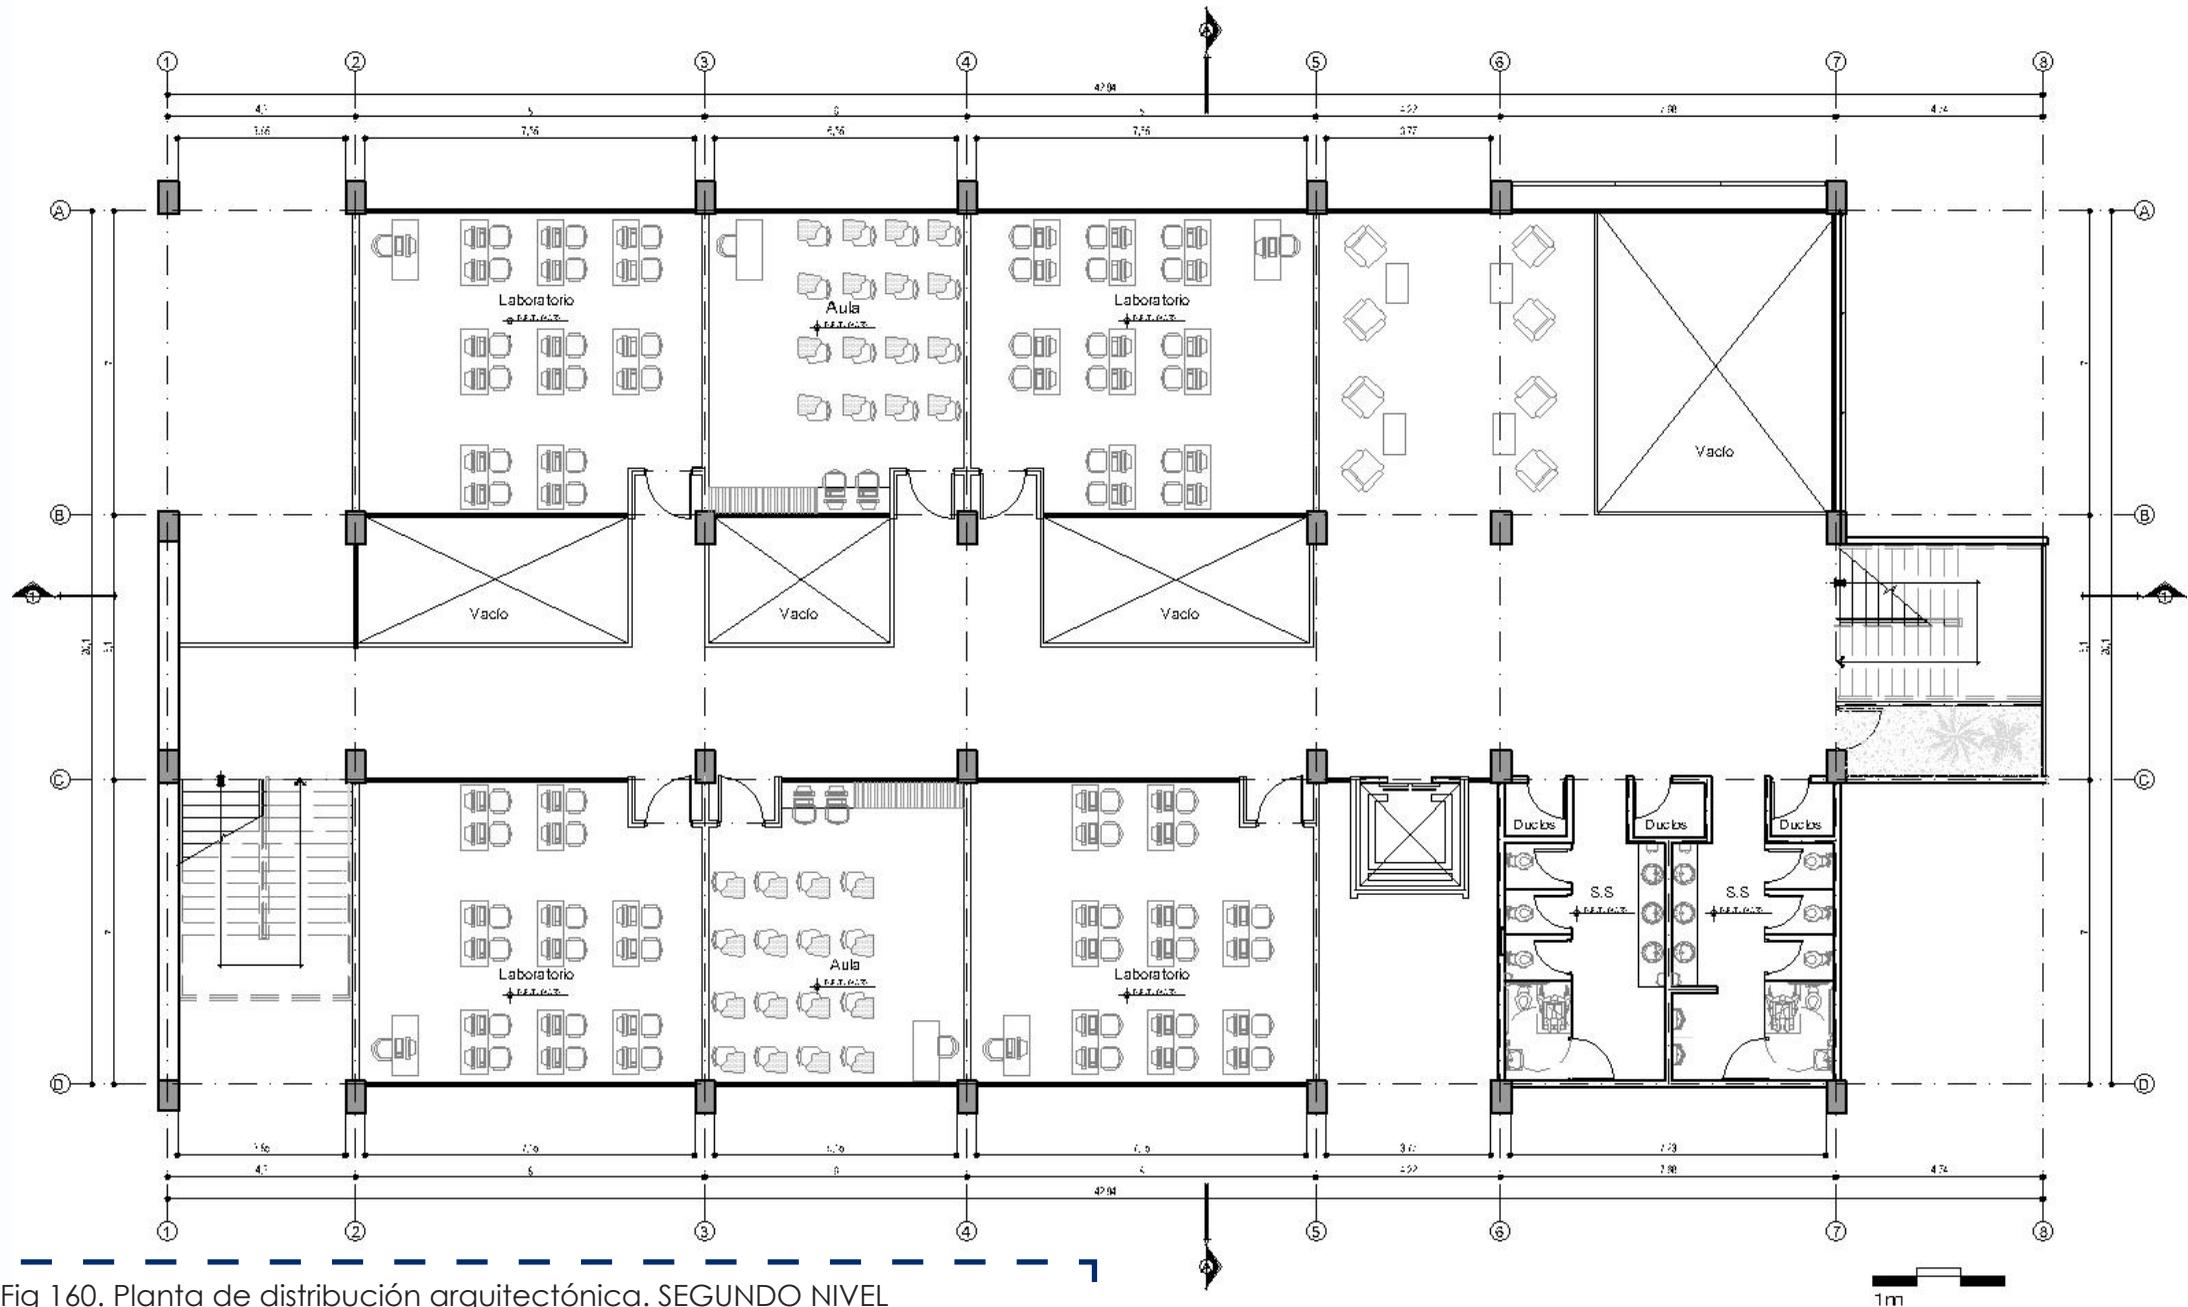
Planta de distribución arquitectónica. SEGUNDO NIVEL
